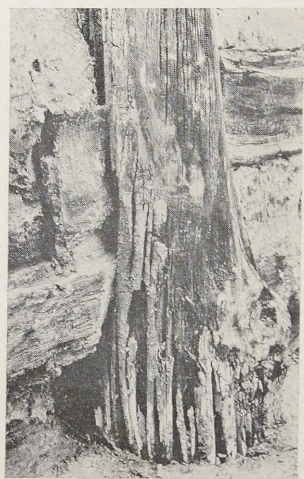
a) und b) Detail Holzkonstruktion Haus 3 Westwand.
